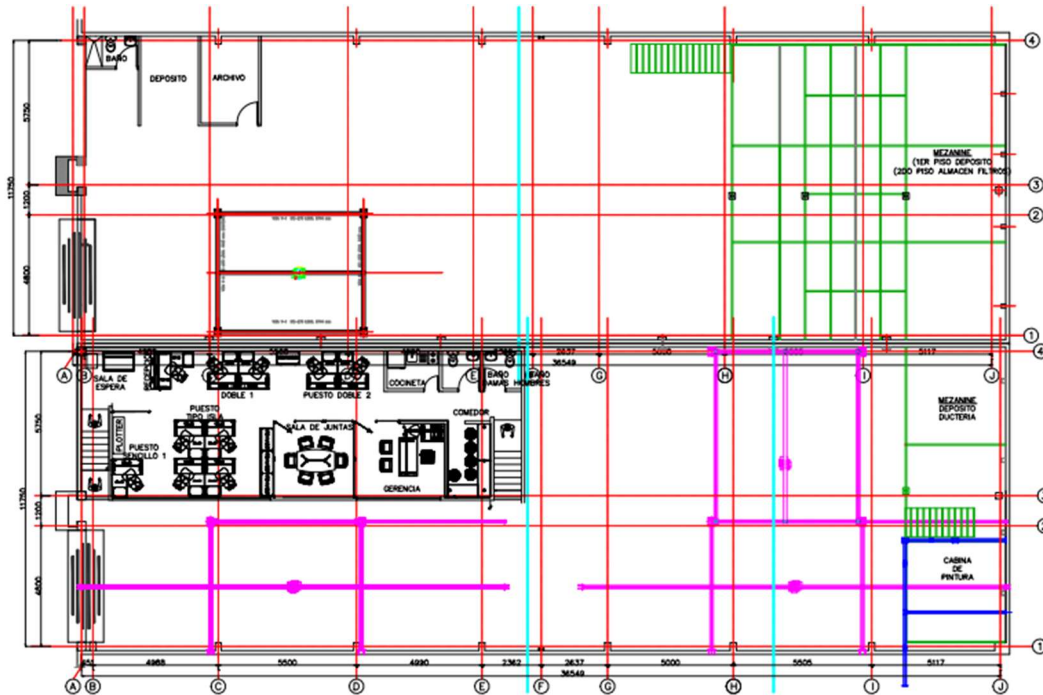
Plano de planta – Primer y Segundo Piso. Fuente: Venfil Ingeniería SAS
